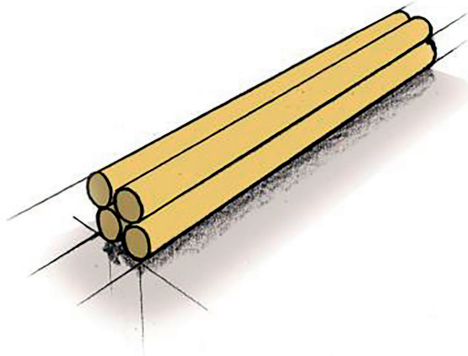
Timber Structures 1.0: Stämme und Balken
